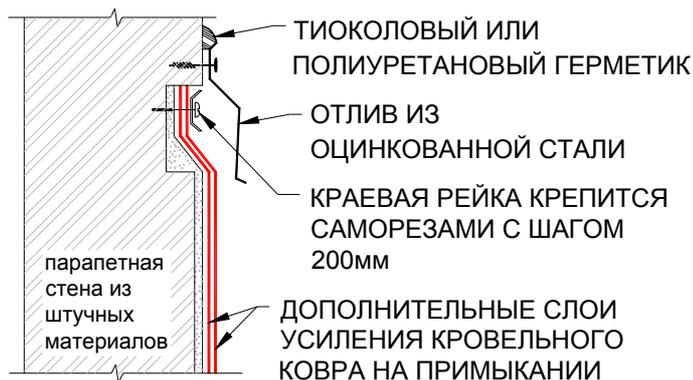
Заведение края кровельного ковра под выдру в парапетной стене.
